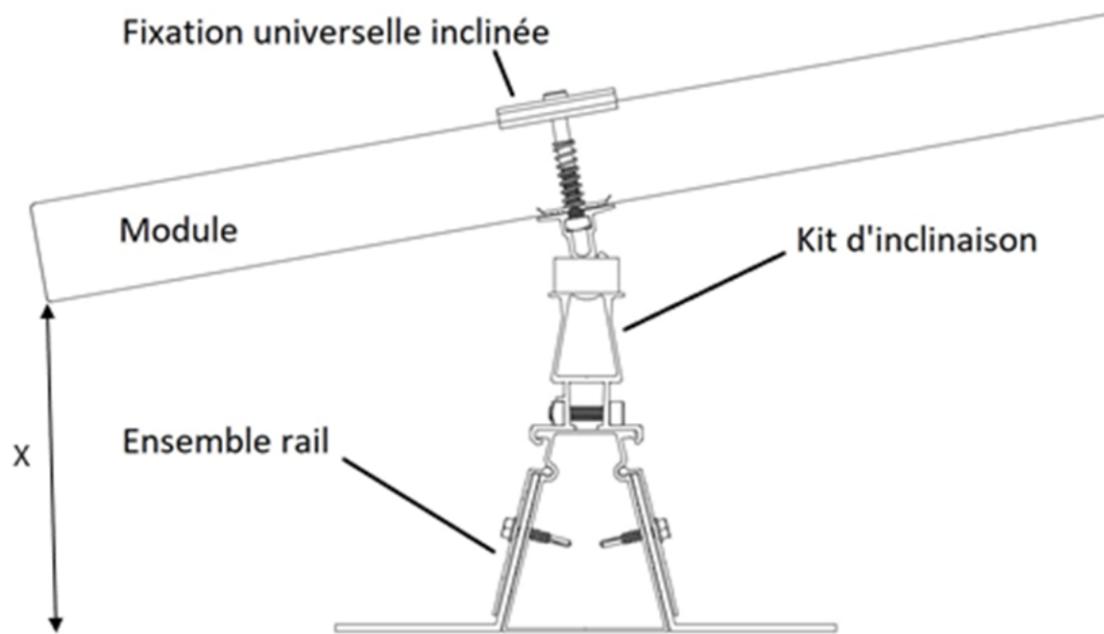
Assemblage rail / kit d'inclinaison / module
